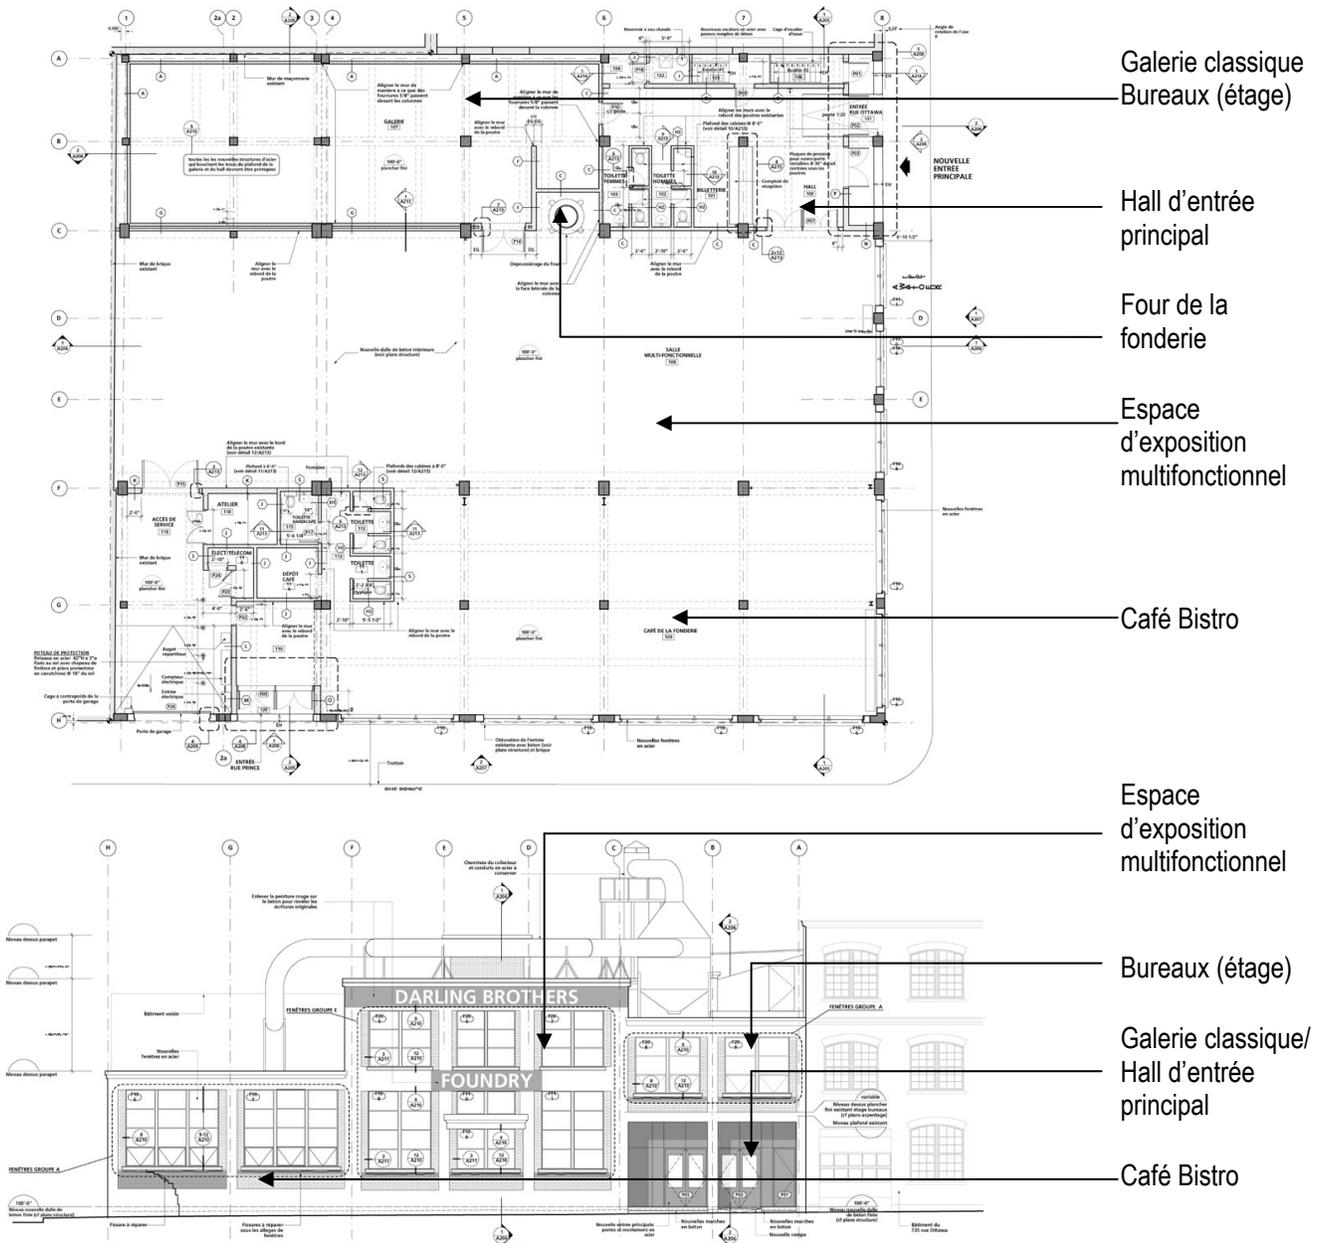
(A) Plan du rez-de-chaussée et (B) élévation rue Ottawa (Source : Atelier in situ)
